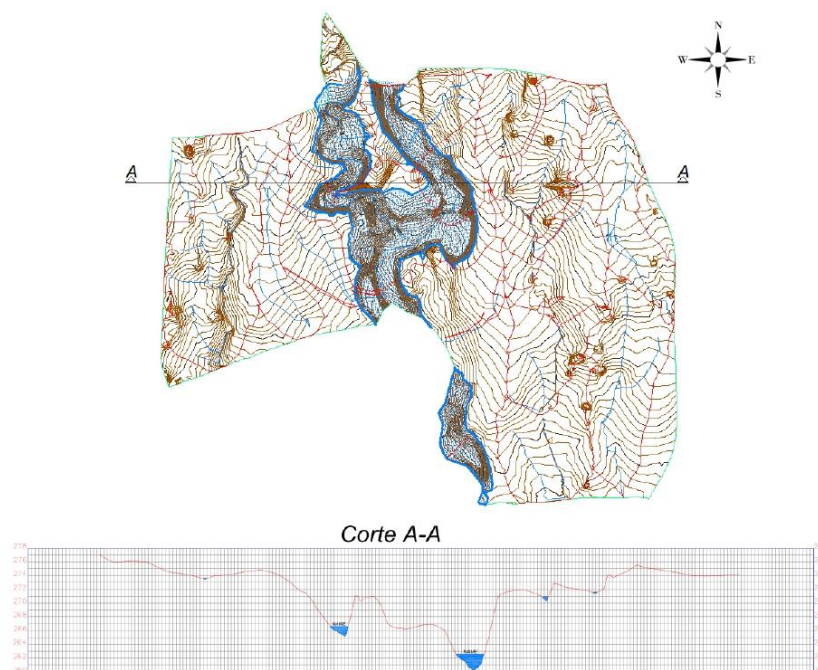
Planta-perfil actual del sistema de drenaje y zonas inundables (Fuente: Propia)
